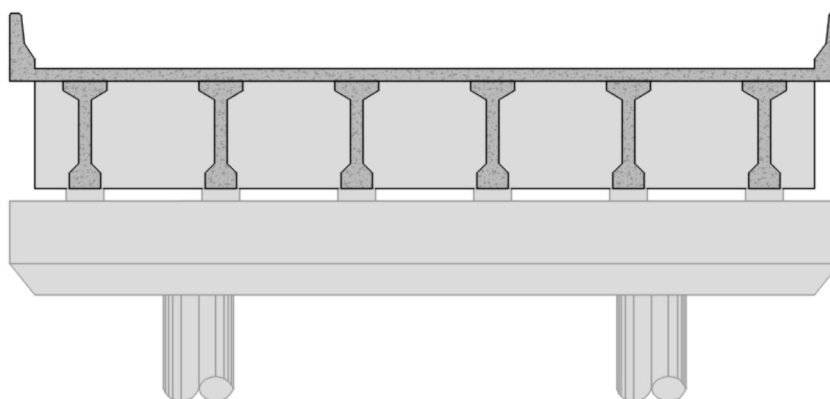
Seção transversal típica de múltiplas vigas de concreto pré-moldadas ou pré-fabricadas.
